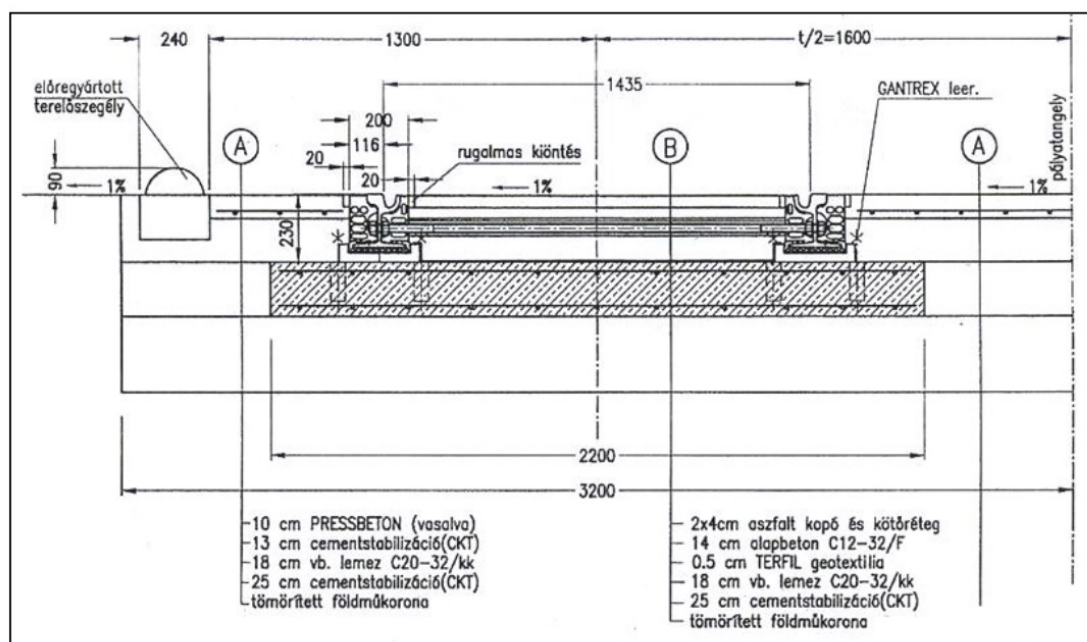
Ejemplo de sección transversal de carril embebido en Budapest [127].
